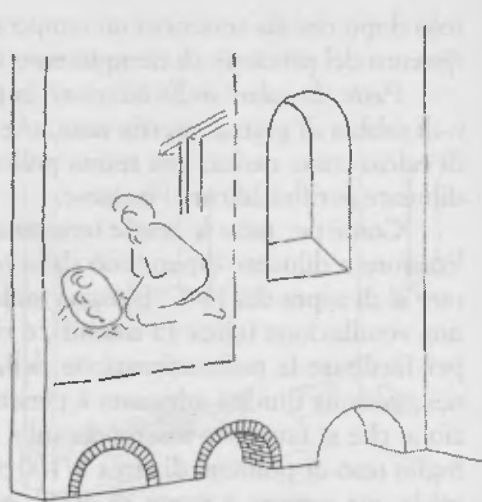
Riduzione della superficie assorbente del muro e costruzione di piccoli archi isolanti di rinforzo.
